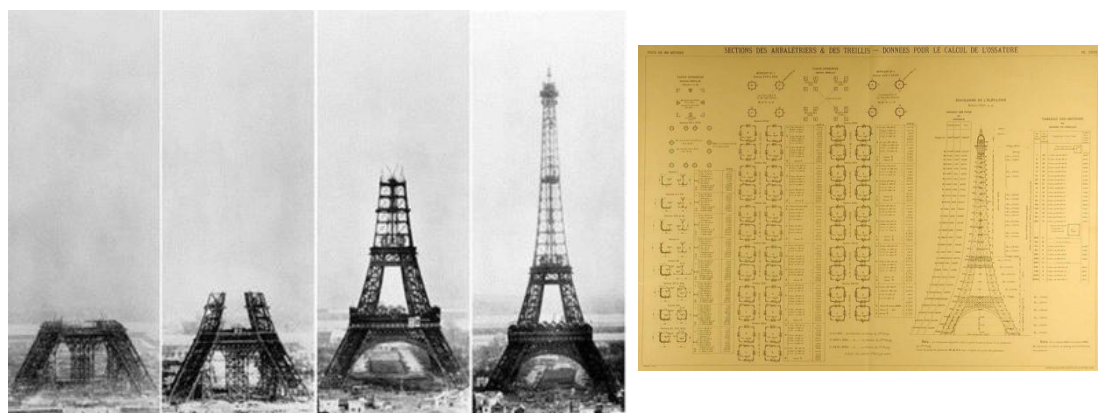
Proceso constructivo de la Torre Eiffel, a la derecha el plano de las piezas estructurales.
